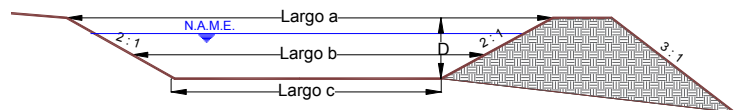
Ejemplo de sección transversal longitudinal (no está a escala)
